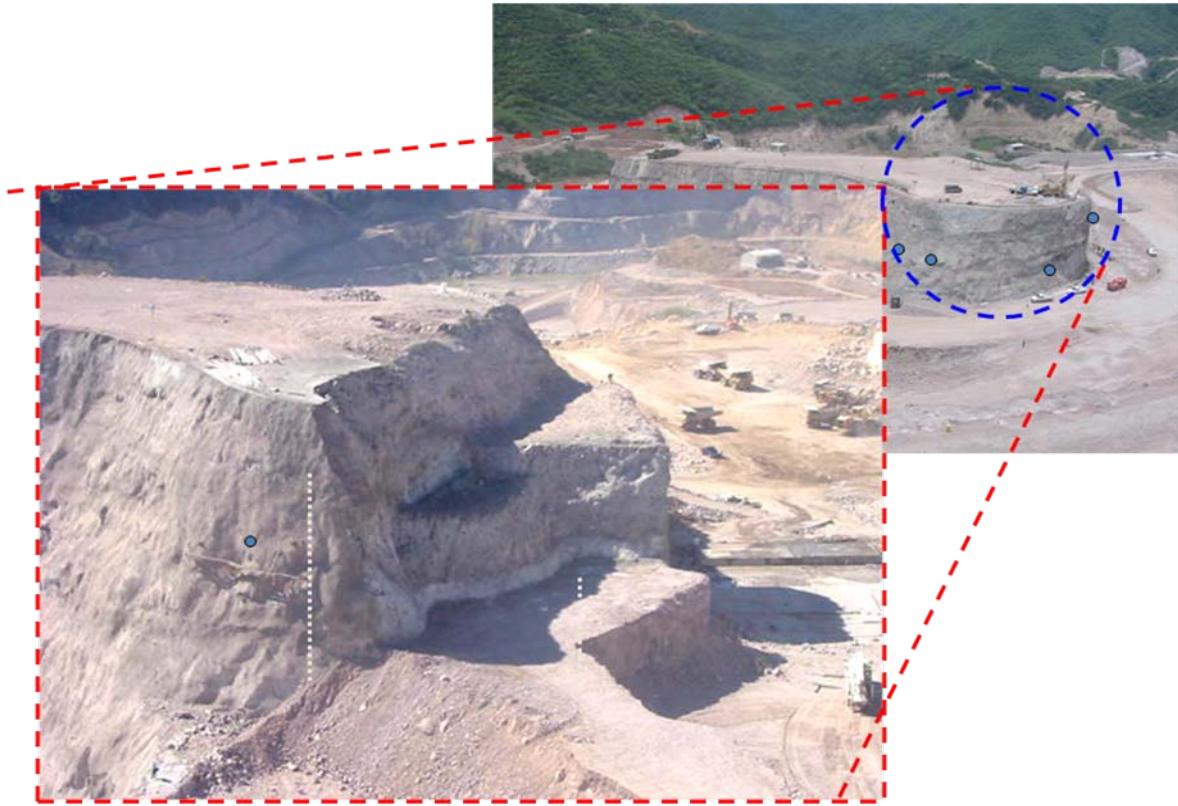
P.H. El Cajón – Vista original del muro alabeado y con la remoción del material inestable.
